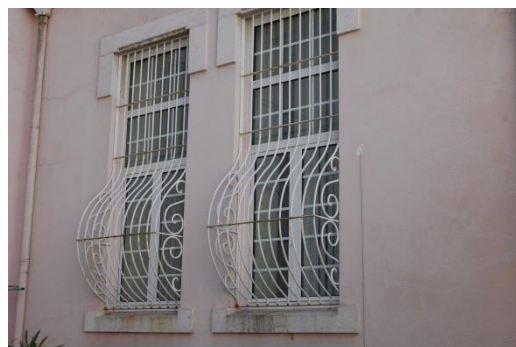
Gradeamento em Ferro para Janelas do andar térreo, na fachada posterior [Fonte: Autora,Data:31-05-2016]
